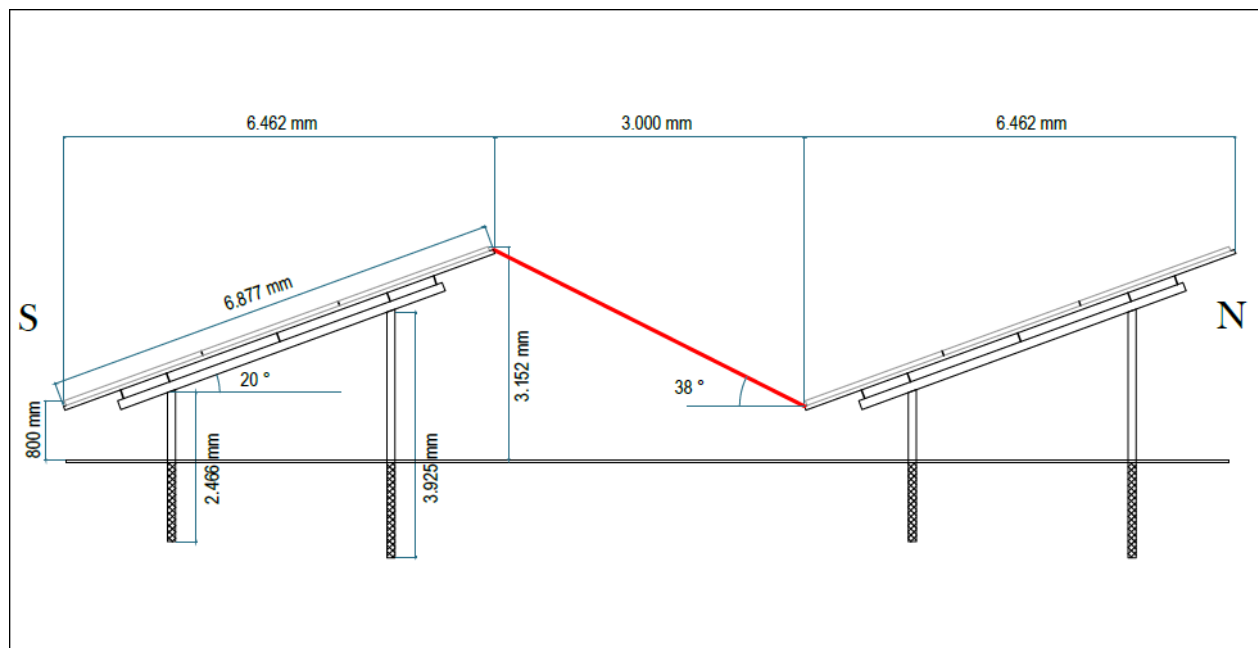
Konzeption Unterkonstruktion: Systemschnitt PV-Module als schematische Darstellung
